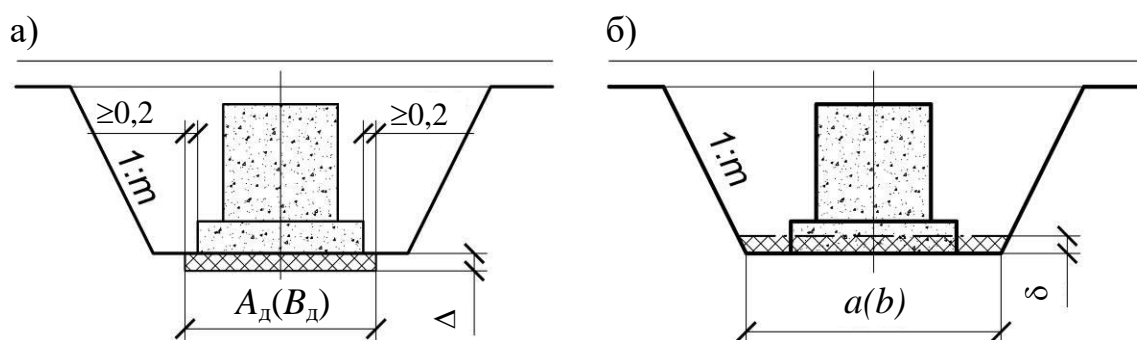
Схема доработки дна выемки: а) для глинистых грунтов; б) для песчаных грунтов
